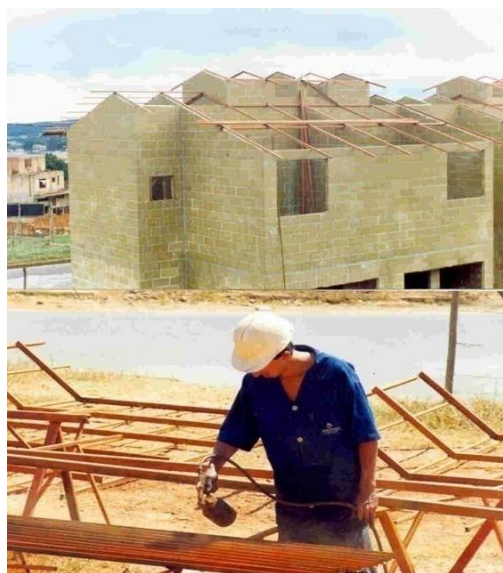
No primeiro plano, trabalha-se a estrutura metálica do telhado. No segundo, peças já instaladas sobre as casas do Urucuia.
